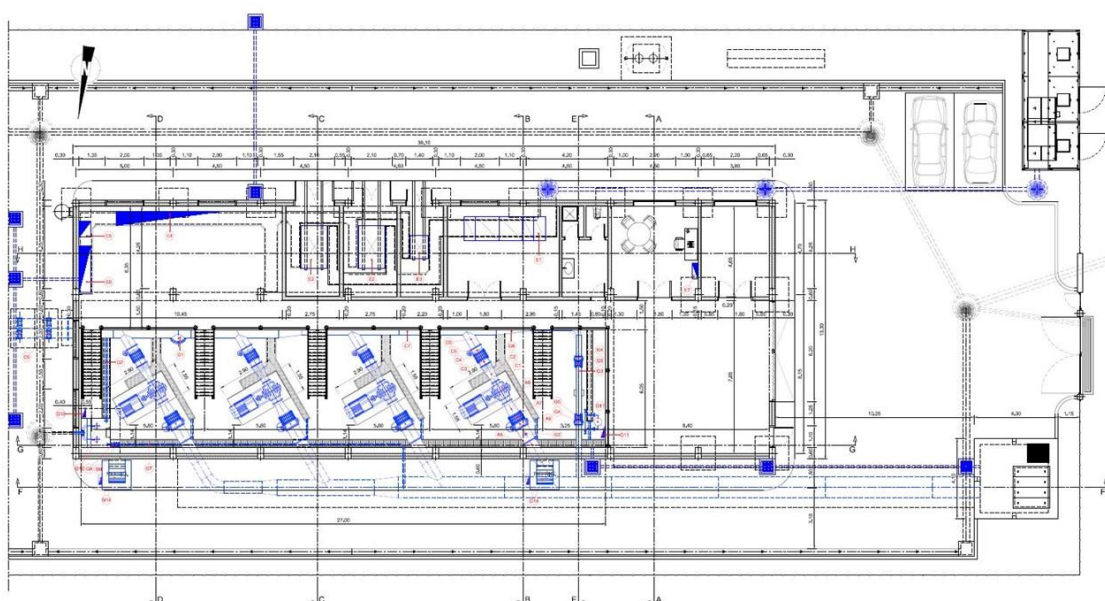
Planta do edifício da estação elevatória (piso à cota 124,10)
